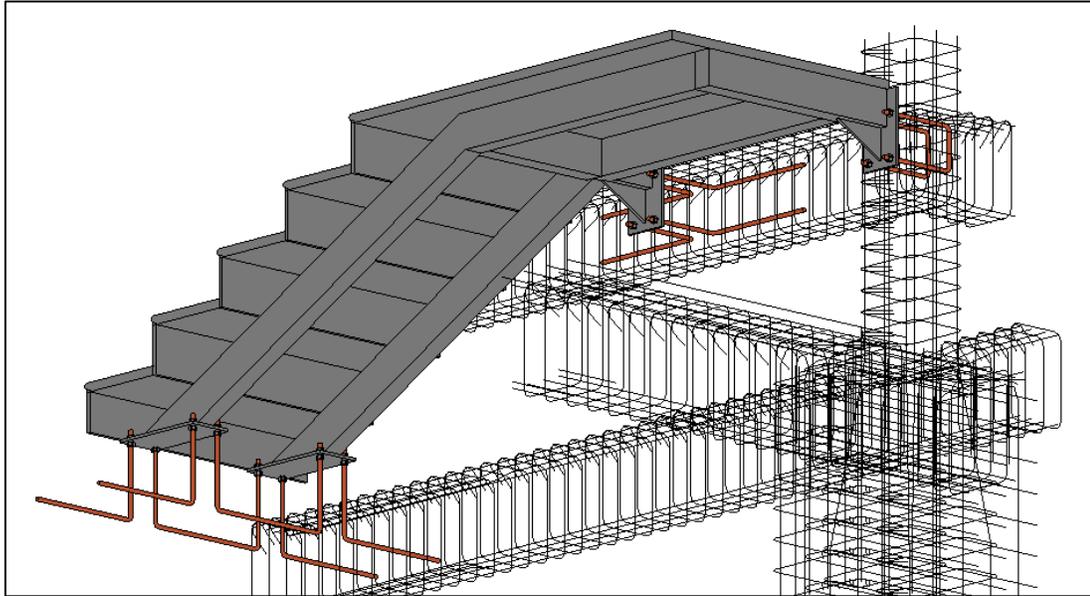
Vista 3D de escalera metálica en PT1 (Torre Shinon)
